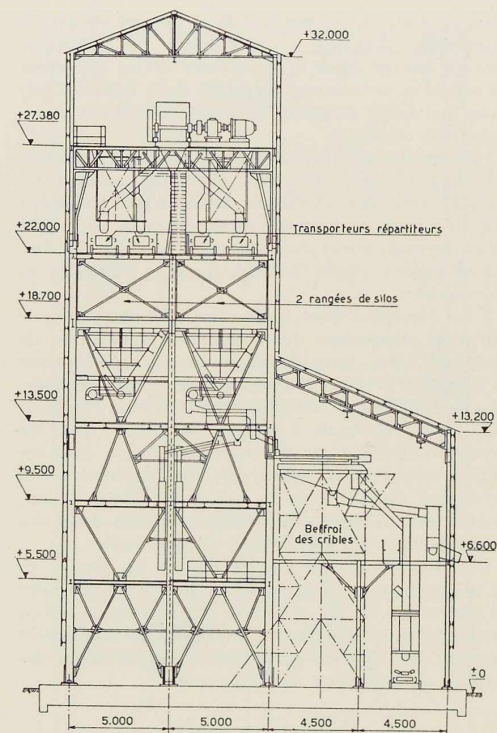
Coupe transversale de l'ossature du bâtiment III (laverie)
